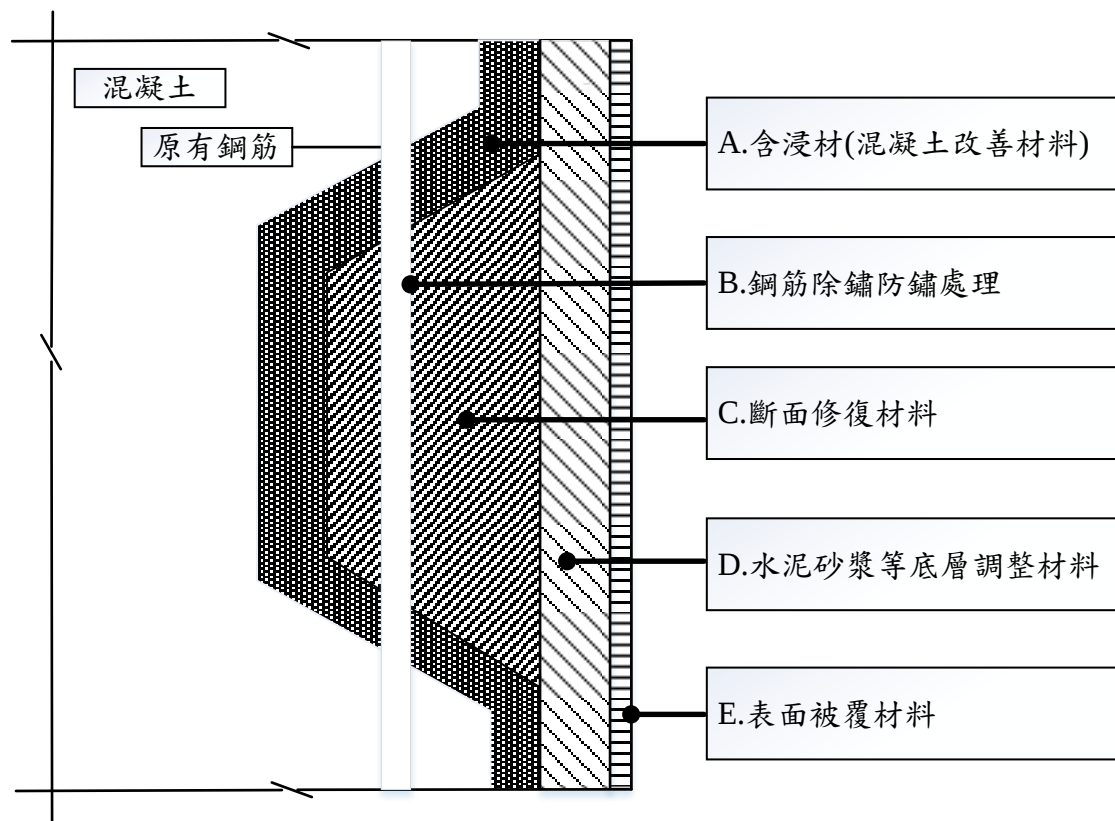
鋼筋混凝土斷面修復解說圖[2.1]
